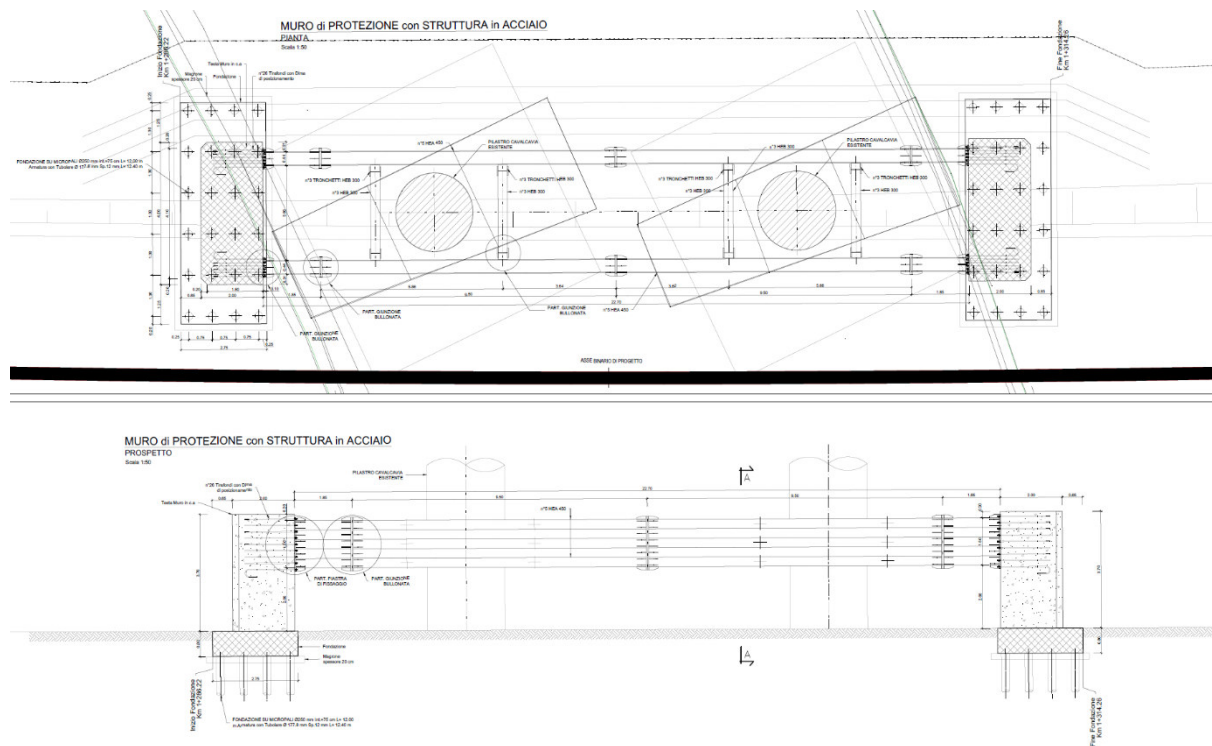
Opera di protezione cavalcaferrovia pk 1+300 (pianta e prospetto)
